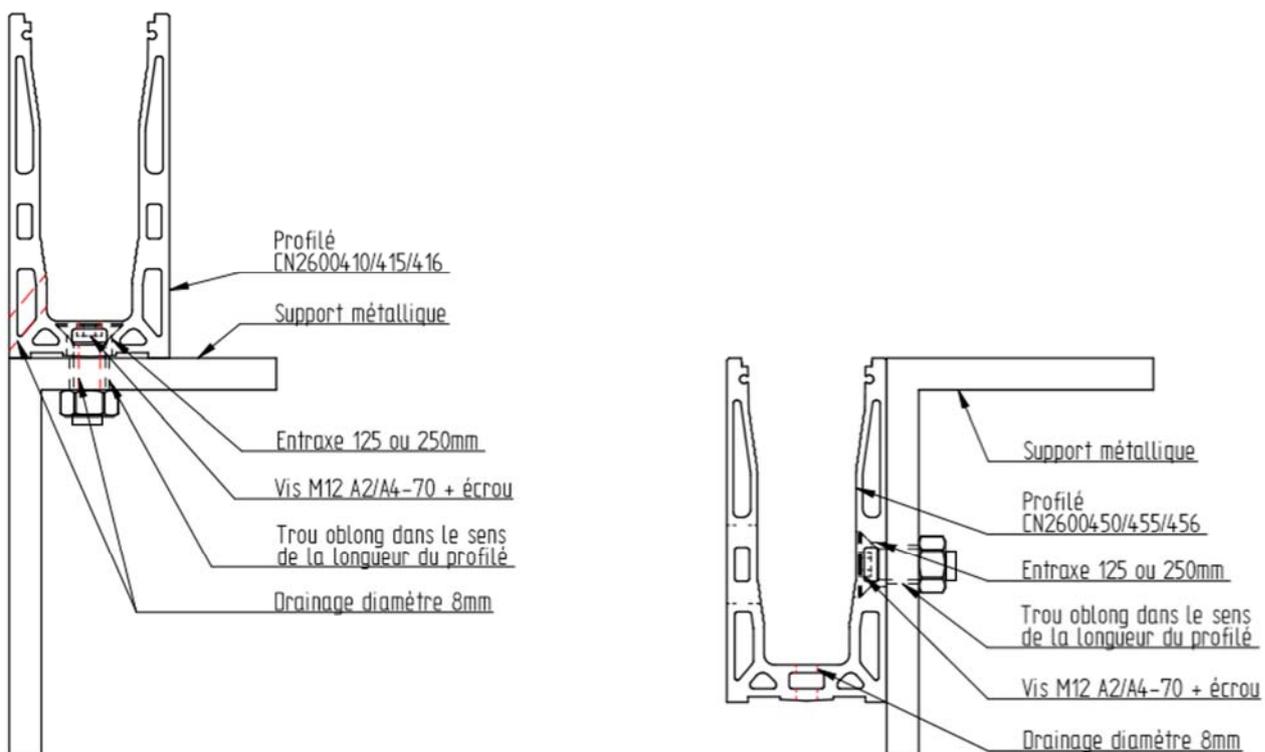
CROSILUX 2.0 LIGHT – Montage en nez de dalle
